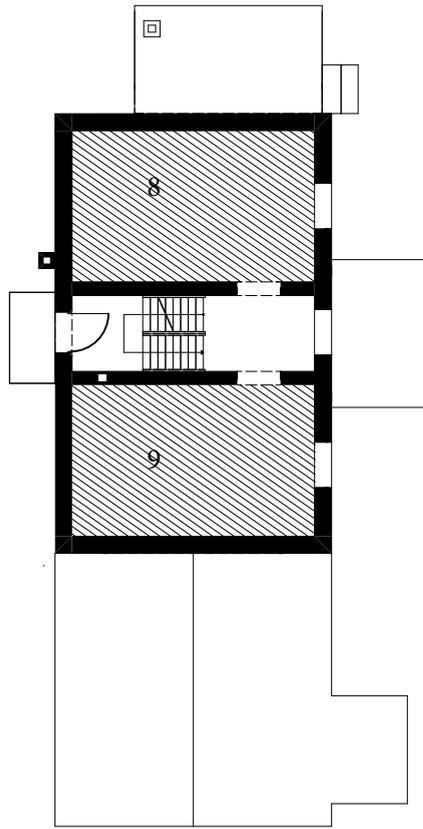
Grundriss Obergeschoss 3. Bauphase 1:200
